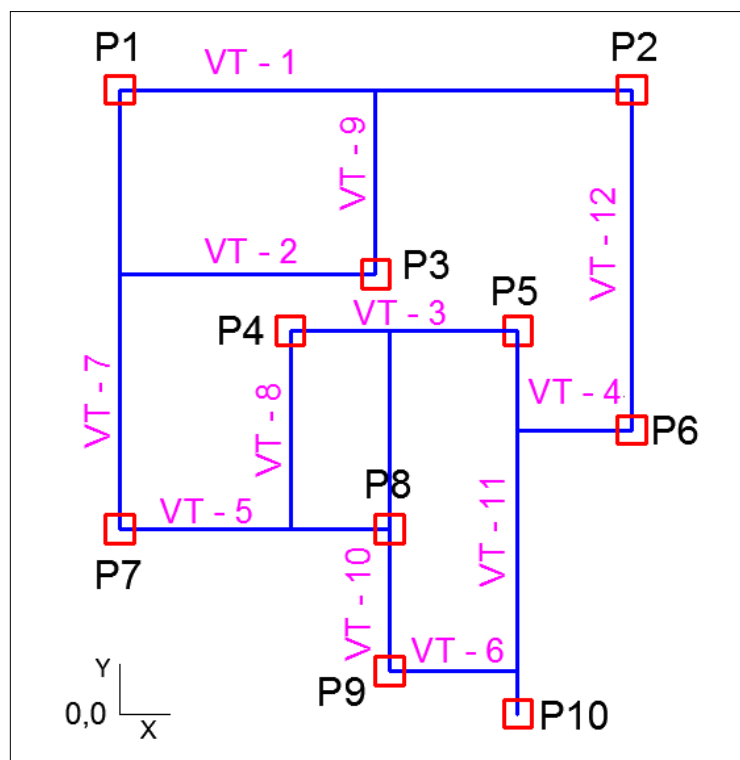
Planta baixa simplificada das vigas de transição do edifício Colubandê 1.
